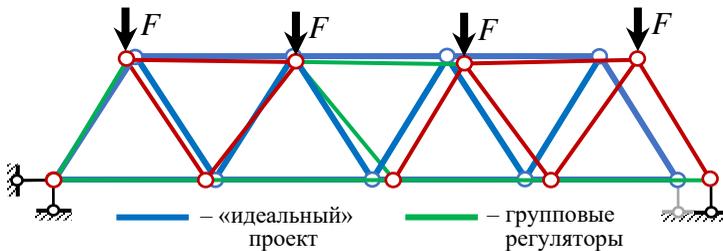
Схема деформированной фермы при действии нагрузки с учетом регулирования
